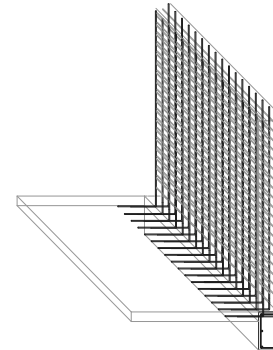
Detalle constructivo de armado para cartelas lateral derecha.
